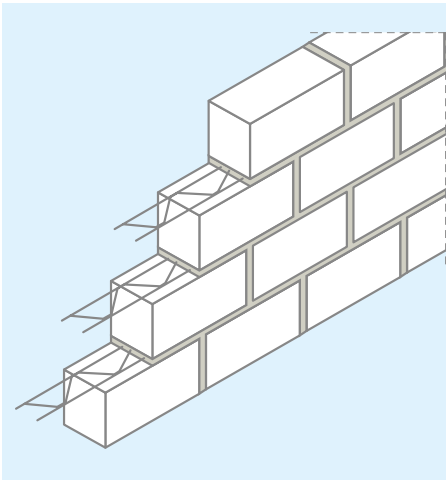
Lagerfugenbewehrung zur konstruktiven Rissicherung
